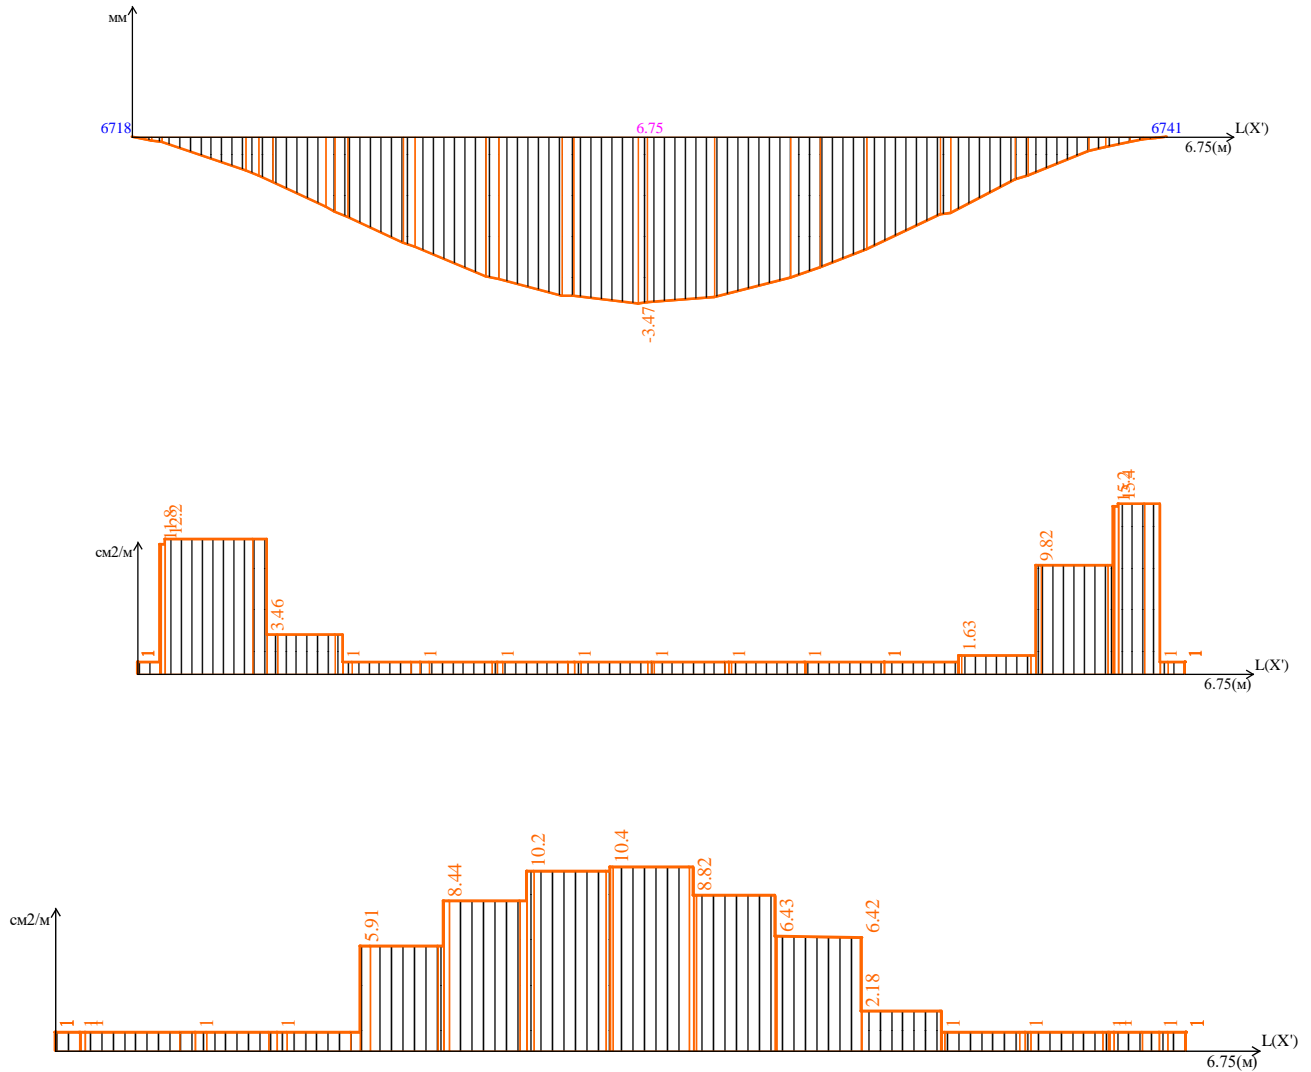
Прогибы перекрытия, верхнее и нижнее армирование в осях А-Б с дополнительной нагрузкой  $200 \text{ кг/м}^2$
